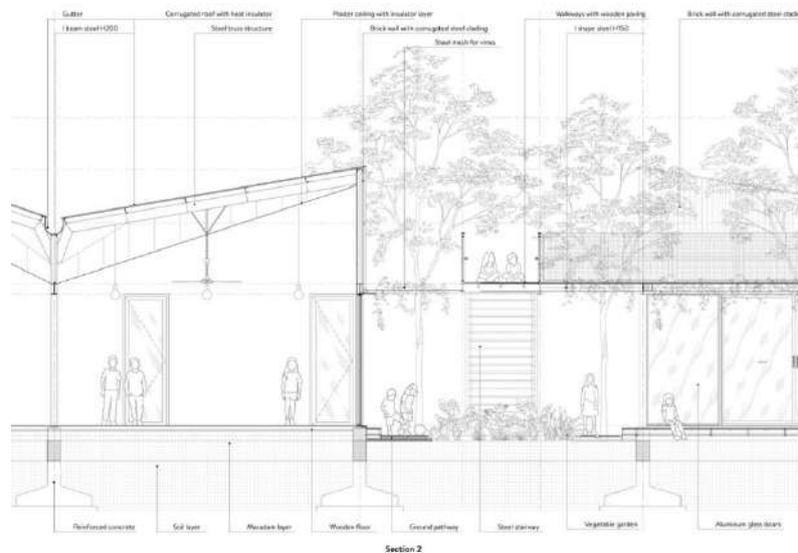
Detalle Constructivo Fuente Plataforma Arquitectura Elaboración: HGAA
